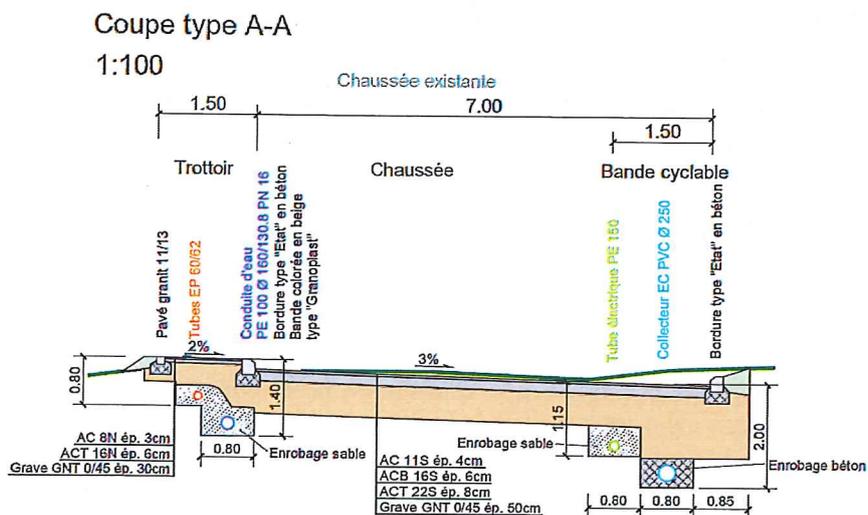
Coupe type A-A, Route de la Gare – Secteur sud
